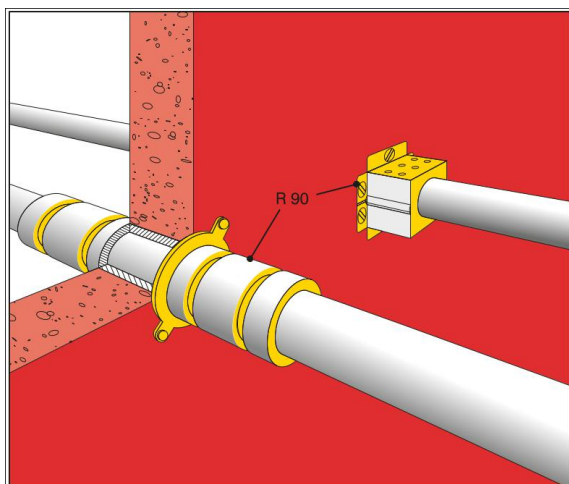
Wanddurchführung für brennbare Rohrleitungen
